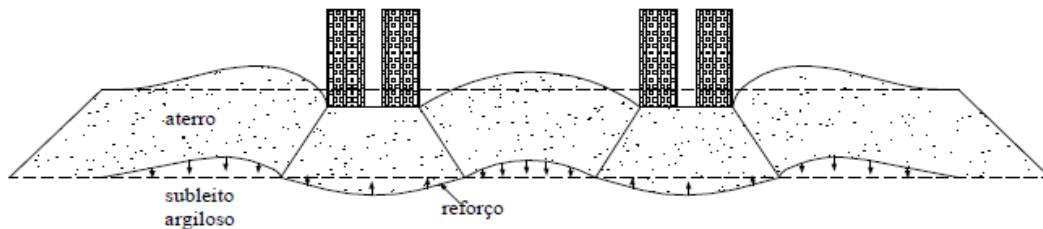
Efeito de membrana em estrada não pavimentada (Pimentel, 2007)
